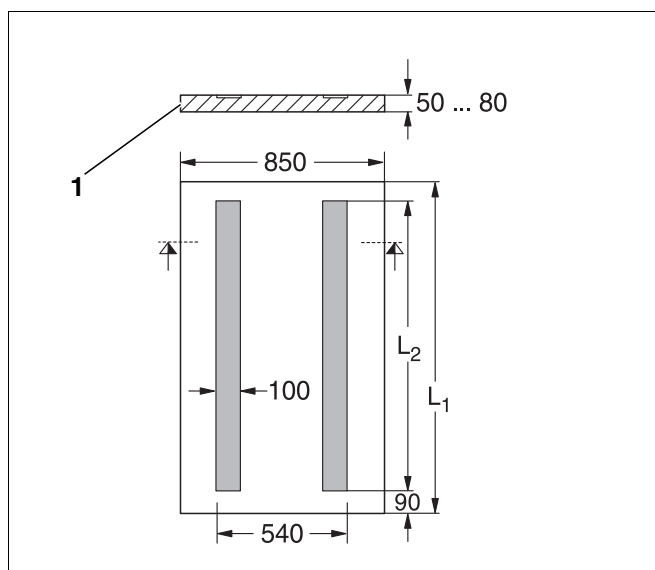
Dimensiunile fundației (dimensiuni în mm)
